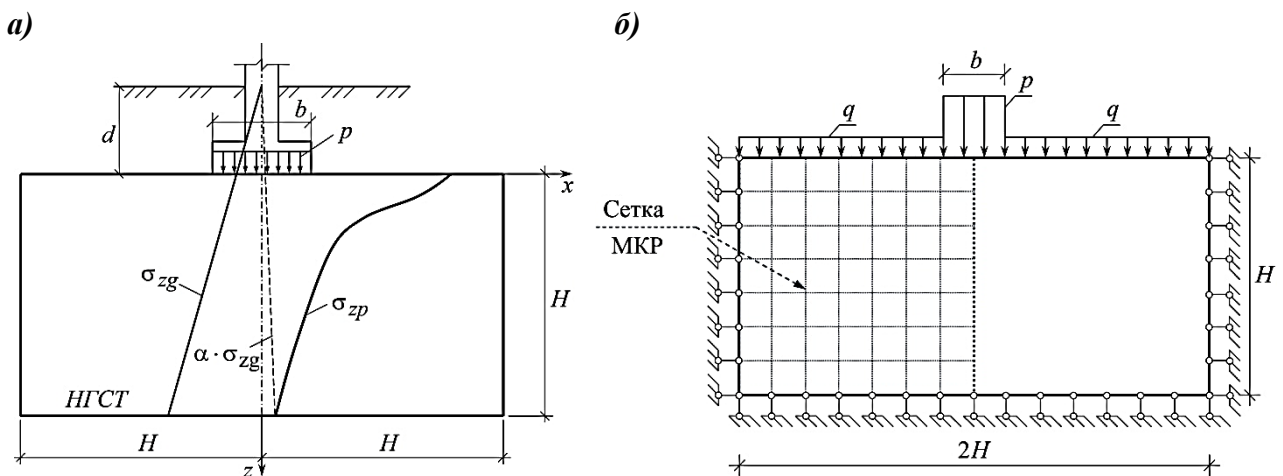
Грунтовое основание центрально нагруженного ленточного фундамента: а) определение границ плоской области грунтового основания; б) расчётная схема
